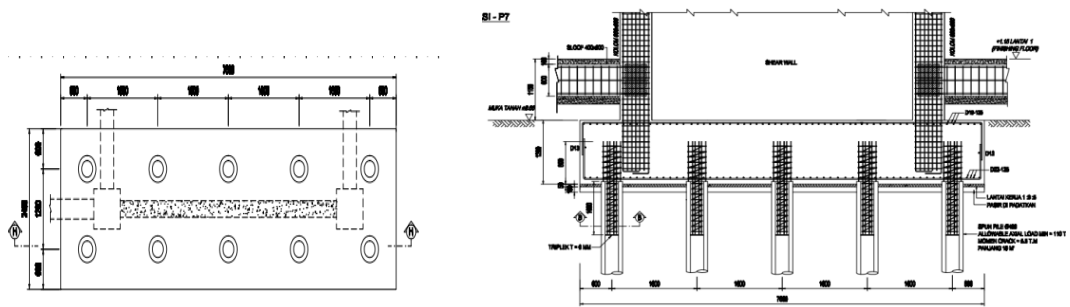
(a) Pondasi 5 Tampak Atas (b) Pondasi 5 Tampak Samping
